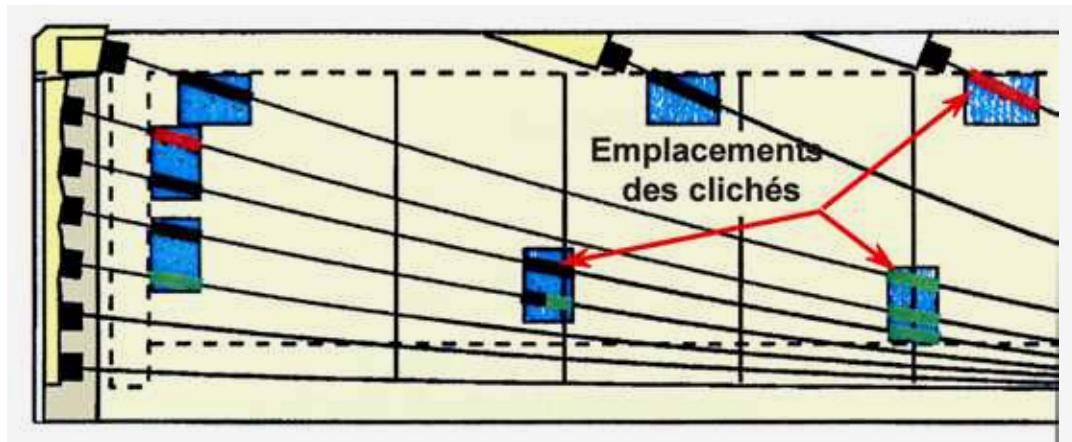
plan de câblage d'une poutre et emplacement des clichés (Extrait du guide méthodologique susvisé)
